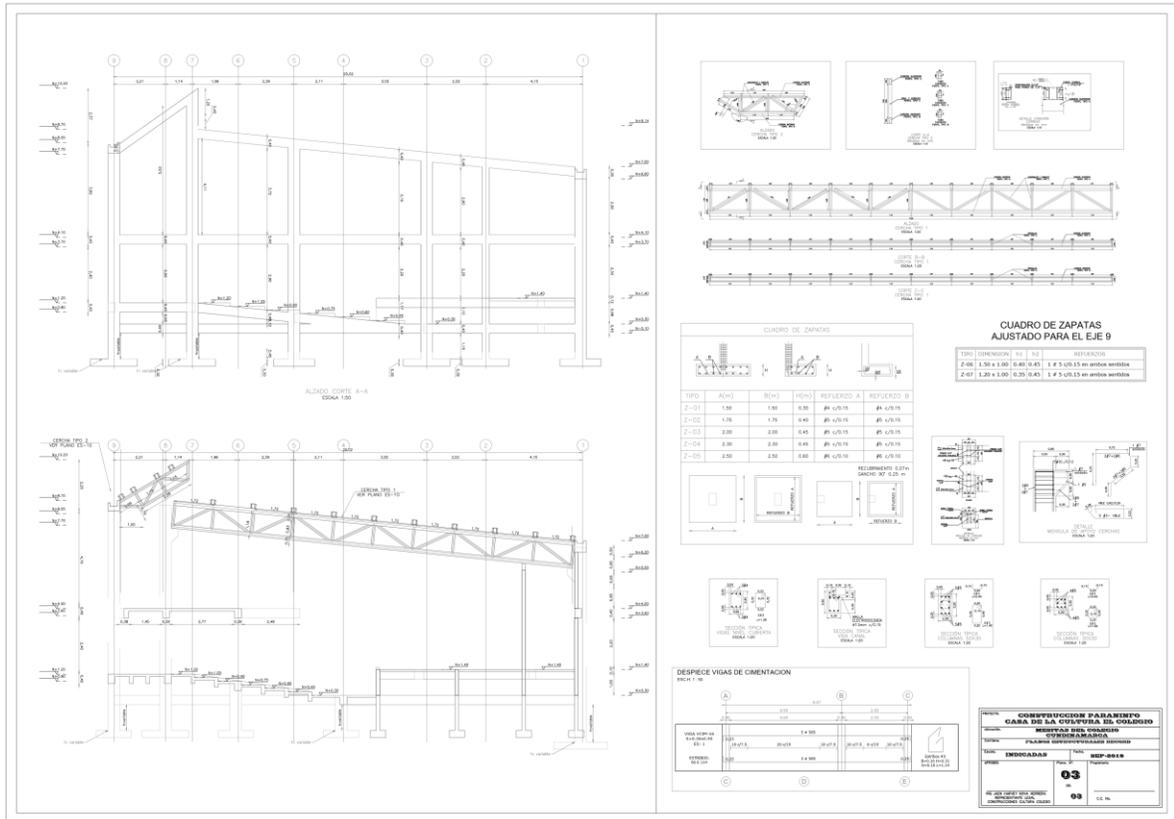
/ Parainfo, Planos record, Corte estructural/ Propio
